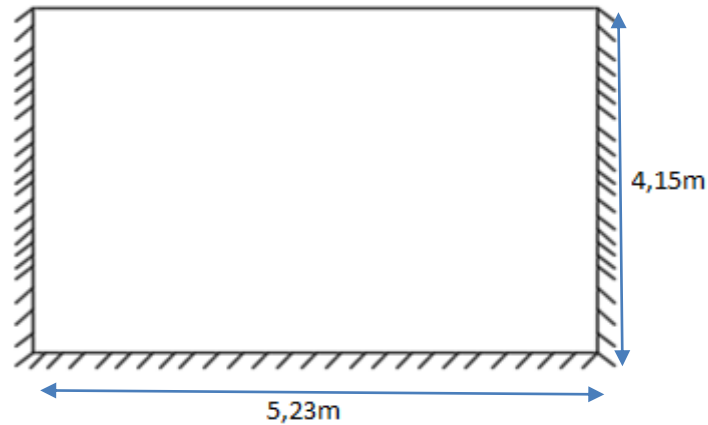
Dimensions d'une dalle pleine rectangulaire.
